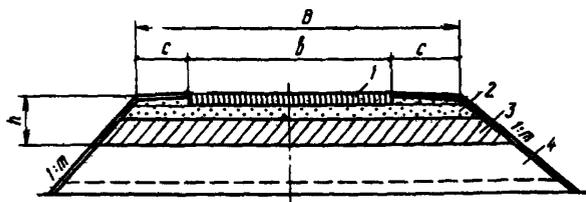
Конструкция насыпи из грунтов повышенной влажности с рабочим слоем из грунта допустимой влажности: 1 - основание и покрытие; 2 - морозозащитный (дренирующий) слой; 3 - рабочий слой из грунта допустимой влажности с $K_y = 1 \pm 0,98$; 4 - тело насыпи из грунта повышенной влажности с $K_y \geq 0,93$
